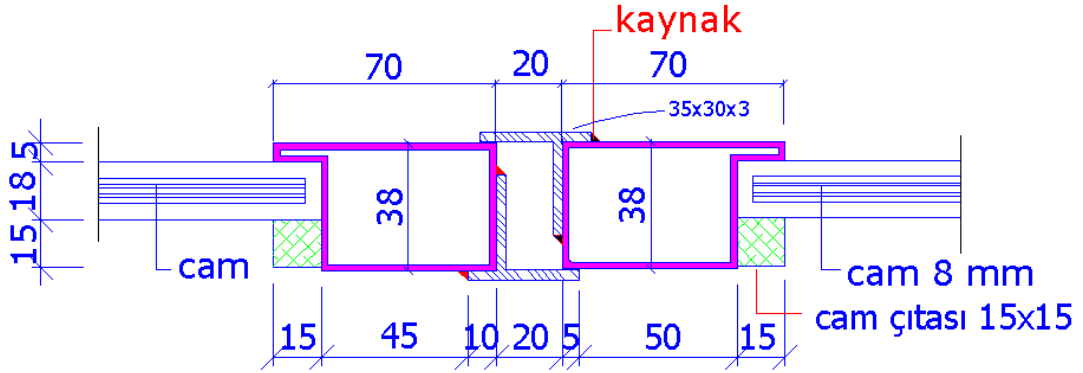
Çift açılırlı çelik pencere planı çizimi
